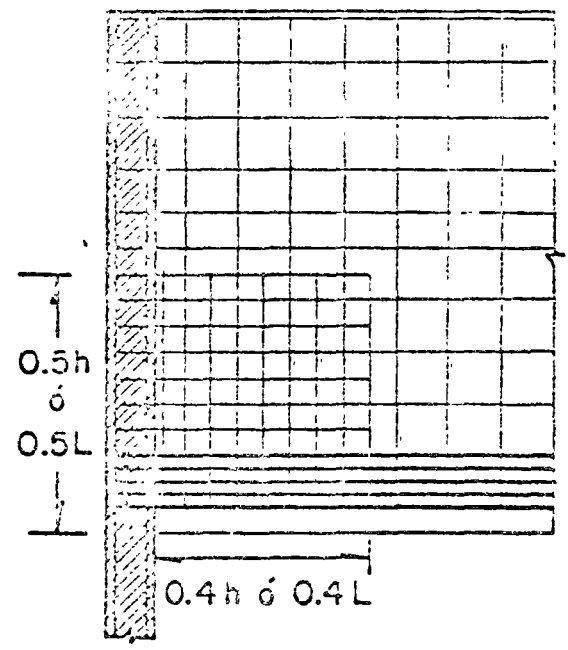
Refuerzo en una zona de apoyo indirecto
